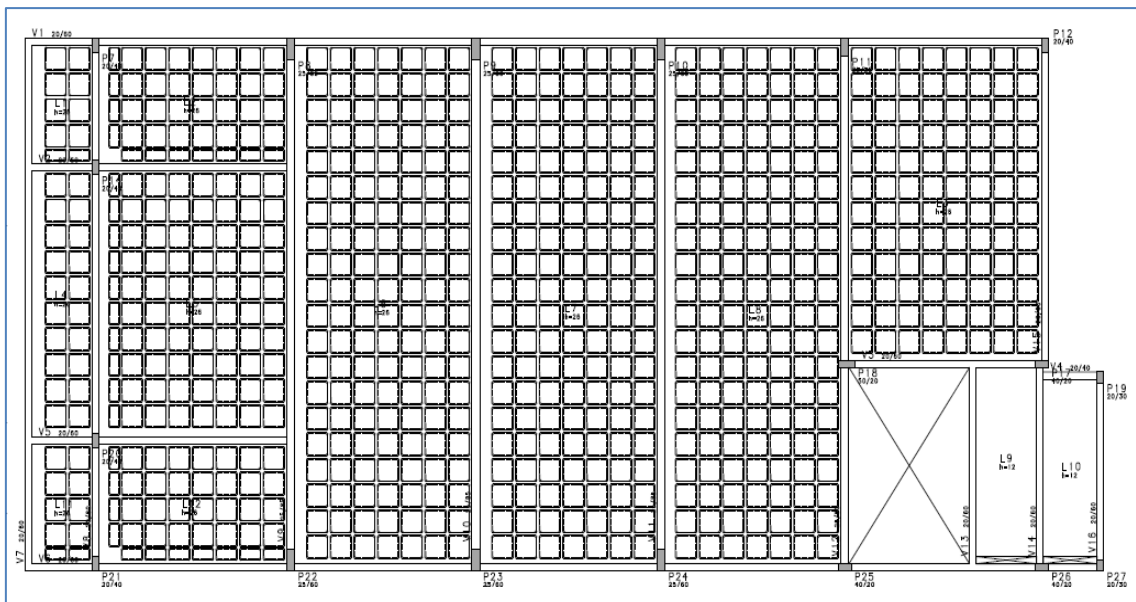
Planta de fôrma: 2º pavimento, concreto protendido (CAD/TQS)
